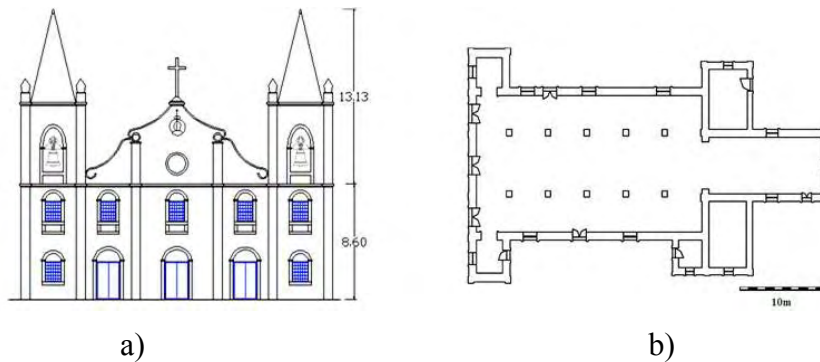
Igreja de Bandeiras – Ilha do Pico (desenhos de [Leão, 1999]): a) Alçado principal, b) Planta
